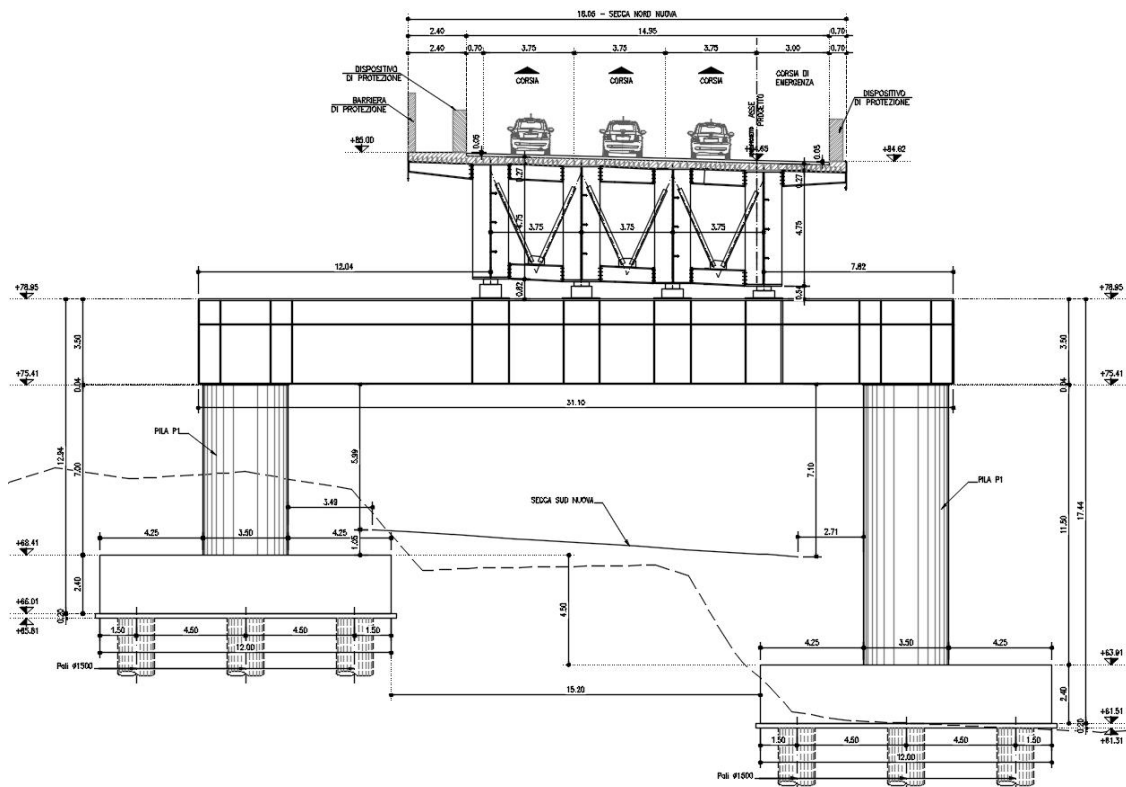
Pila a telaio - Sezione trasversale Pila P1
